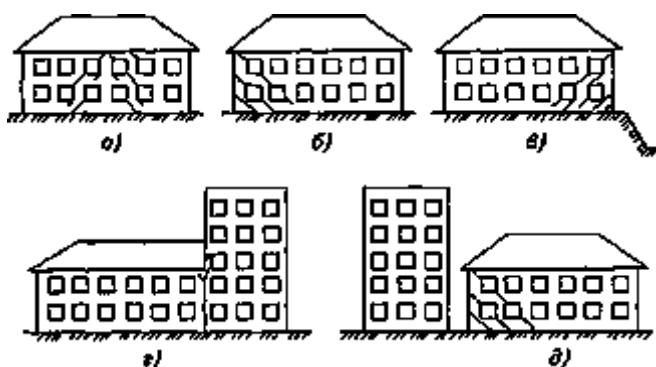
Причины образования трещин в несущих стенах из-за неудовлетворительного состояния оснований и фундаментов:
